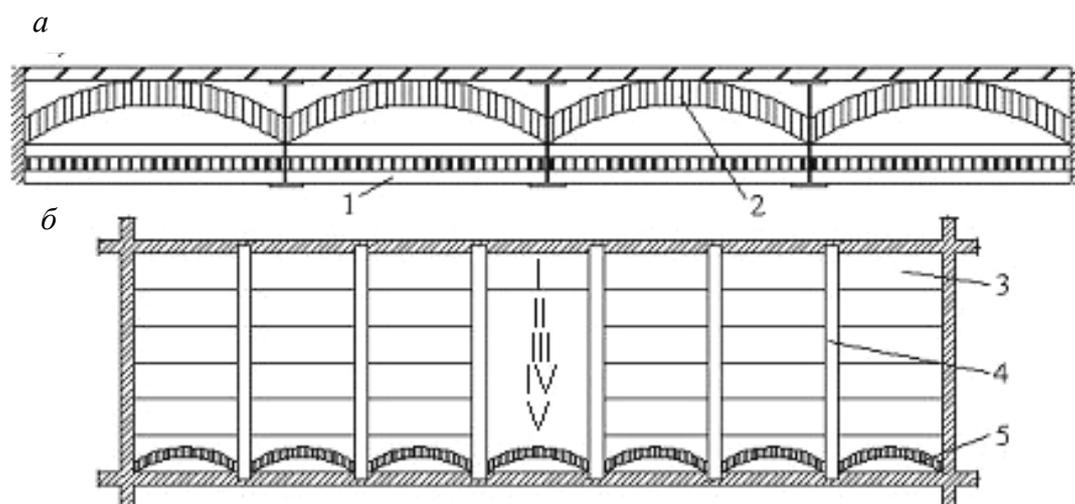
Схема разборки сводов между стальными балками: *а* – расположение деревянных распорок между стальными балками; *б* – разборка сводов поперечными участками; I – V – очередность разборки сводов; 1 – деревянная распорка; 2 – кирпичный свод; 3 – поперечный участок разборки; 4 – стальная балка; 5 – свод на балке
